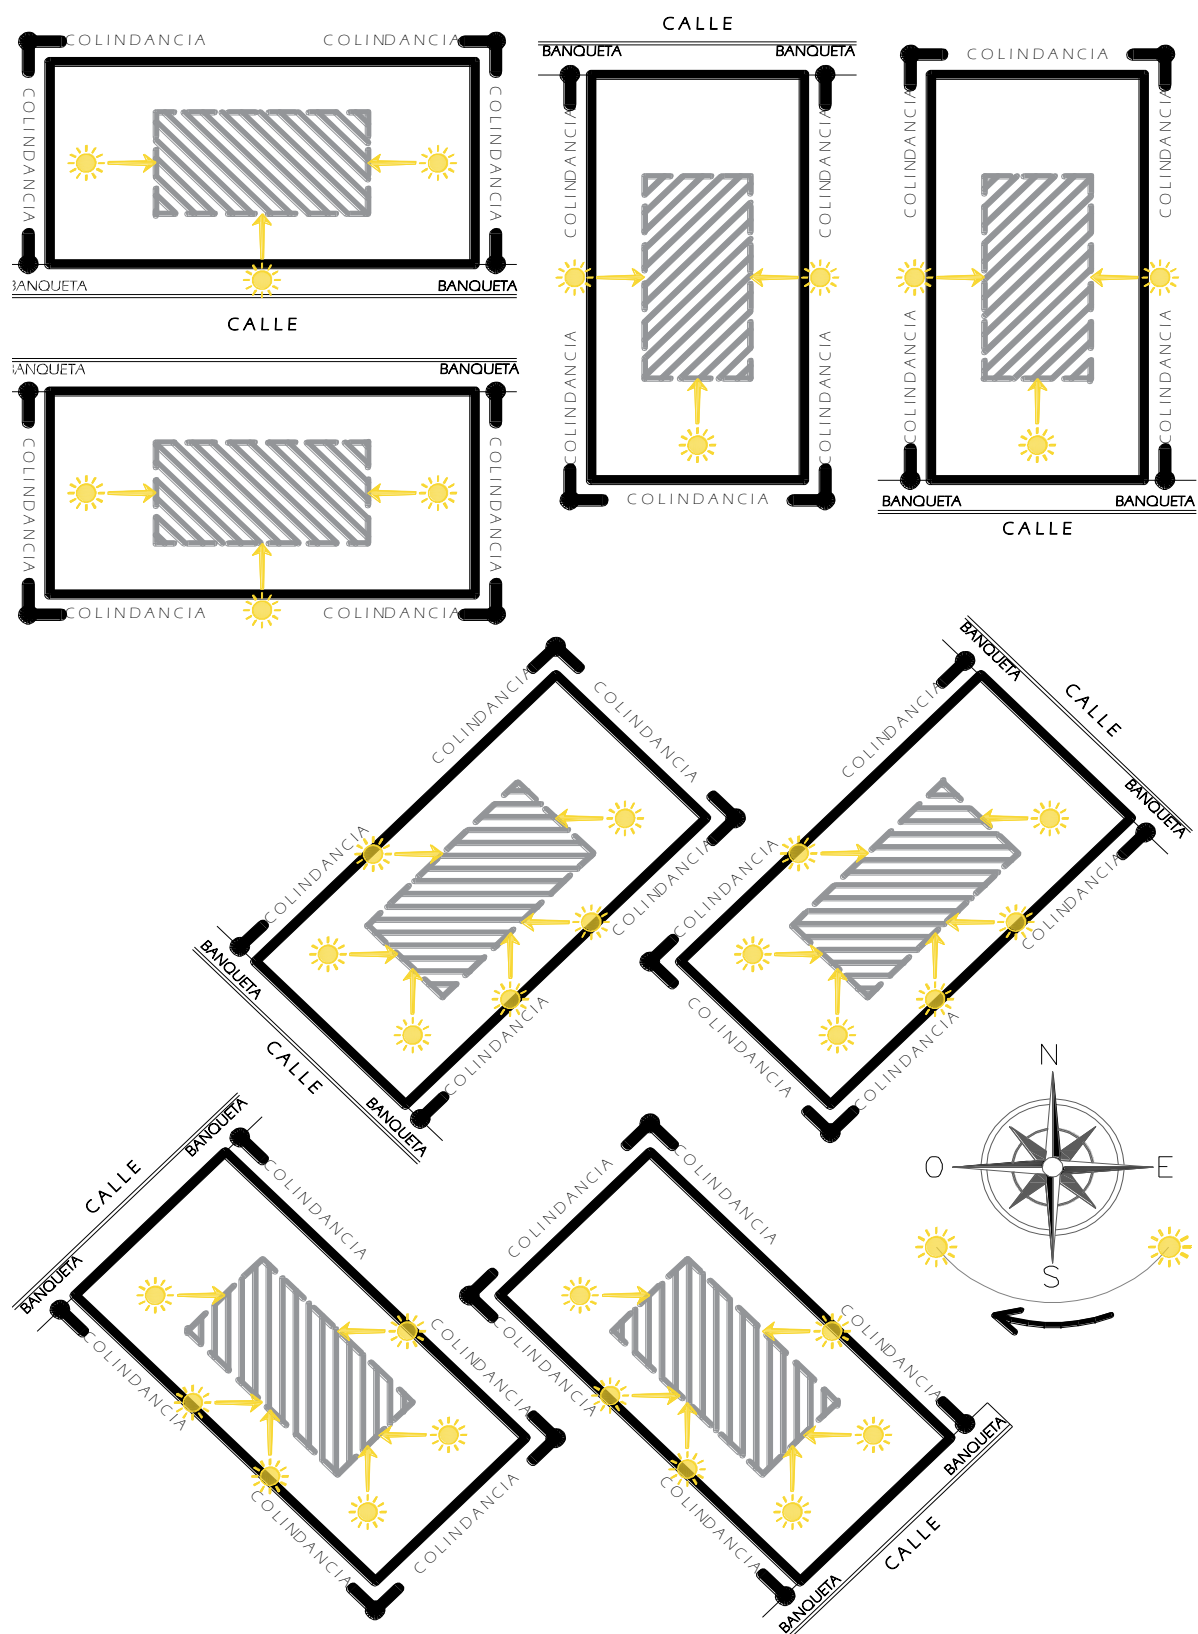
Orientación de fachadas y locales de la vivienda. (Fuente propia).
